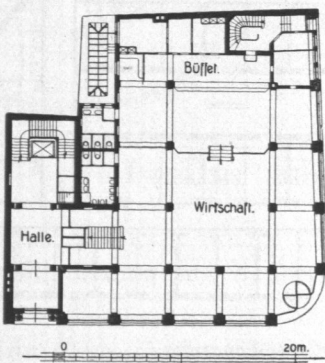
Rathaus-Hotel, Erdgeschoß, Grundriß.
